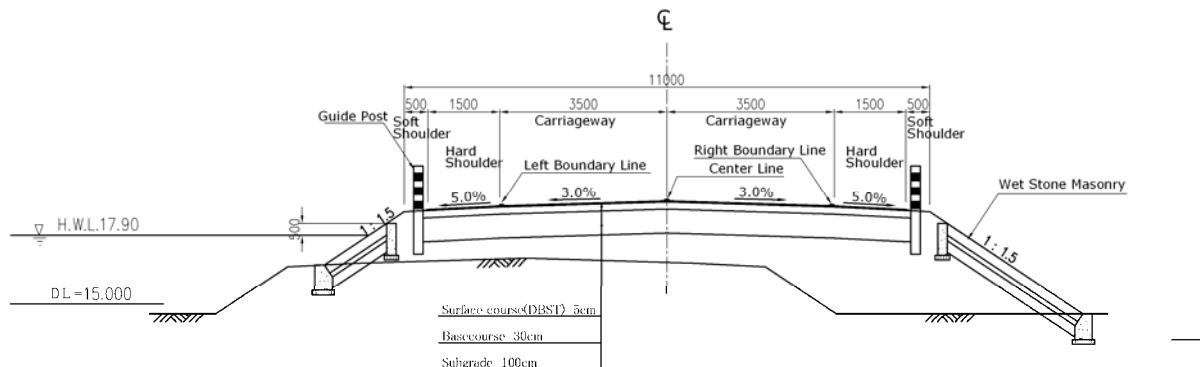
Profil en travers-type de la voie d'accès au pont Dandaya
